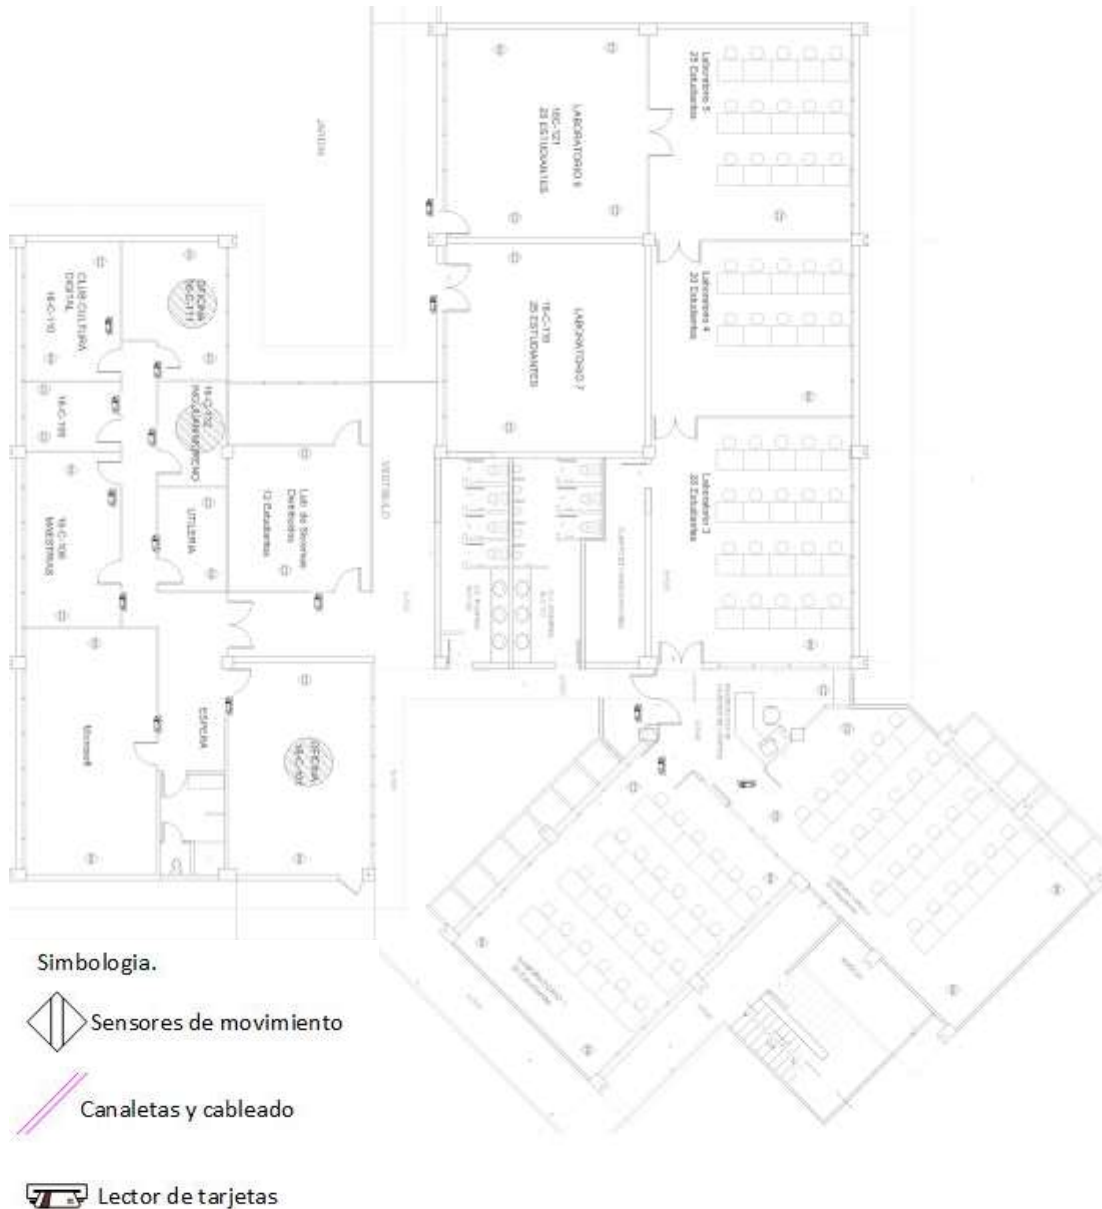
Diseño Estructural del Sistema del bloque 16C planta baja
